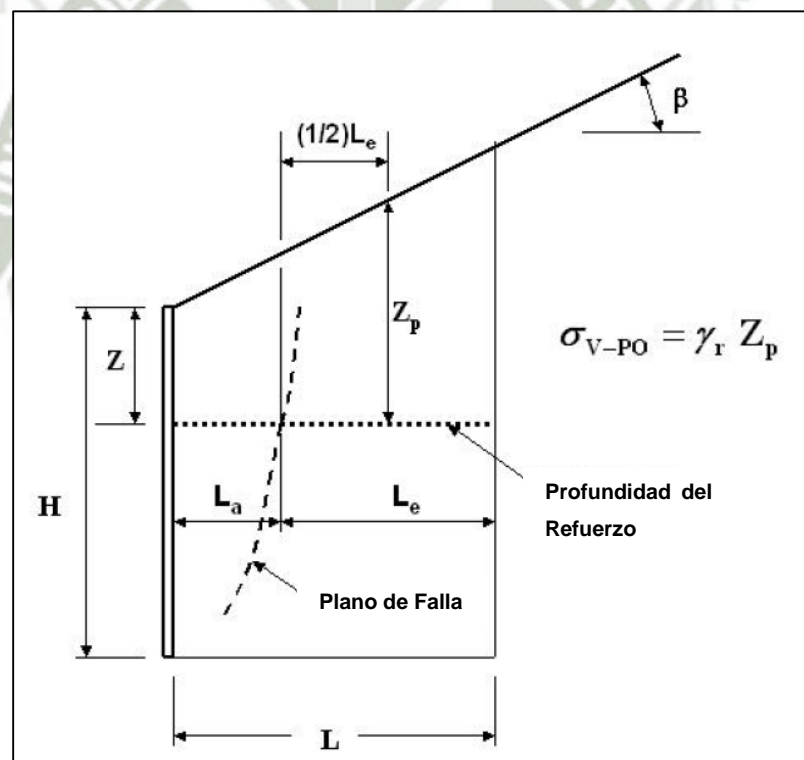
Esfuerzo Vertical con Talud Inclinado (FHWA-NHI-10-024, 2009)
